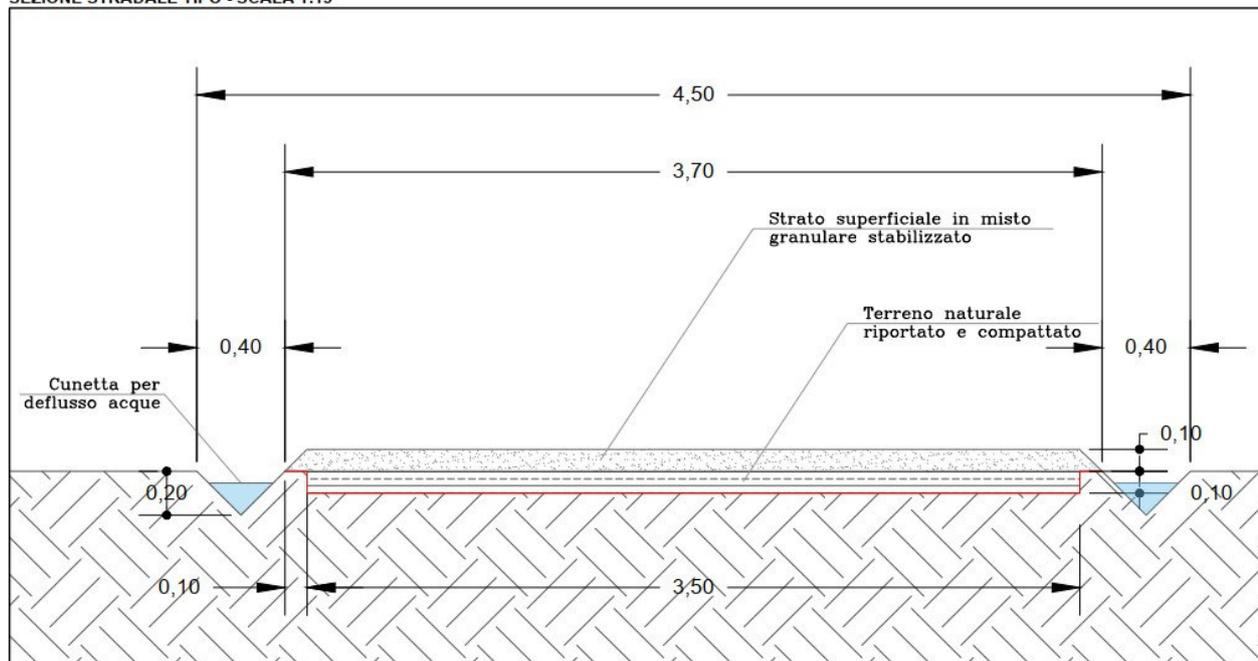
Sezione trasversale strada con indicazione delle cunette
